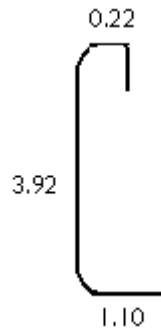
Détail du ferrailage longitudinal du rideau (face extérieure).
